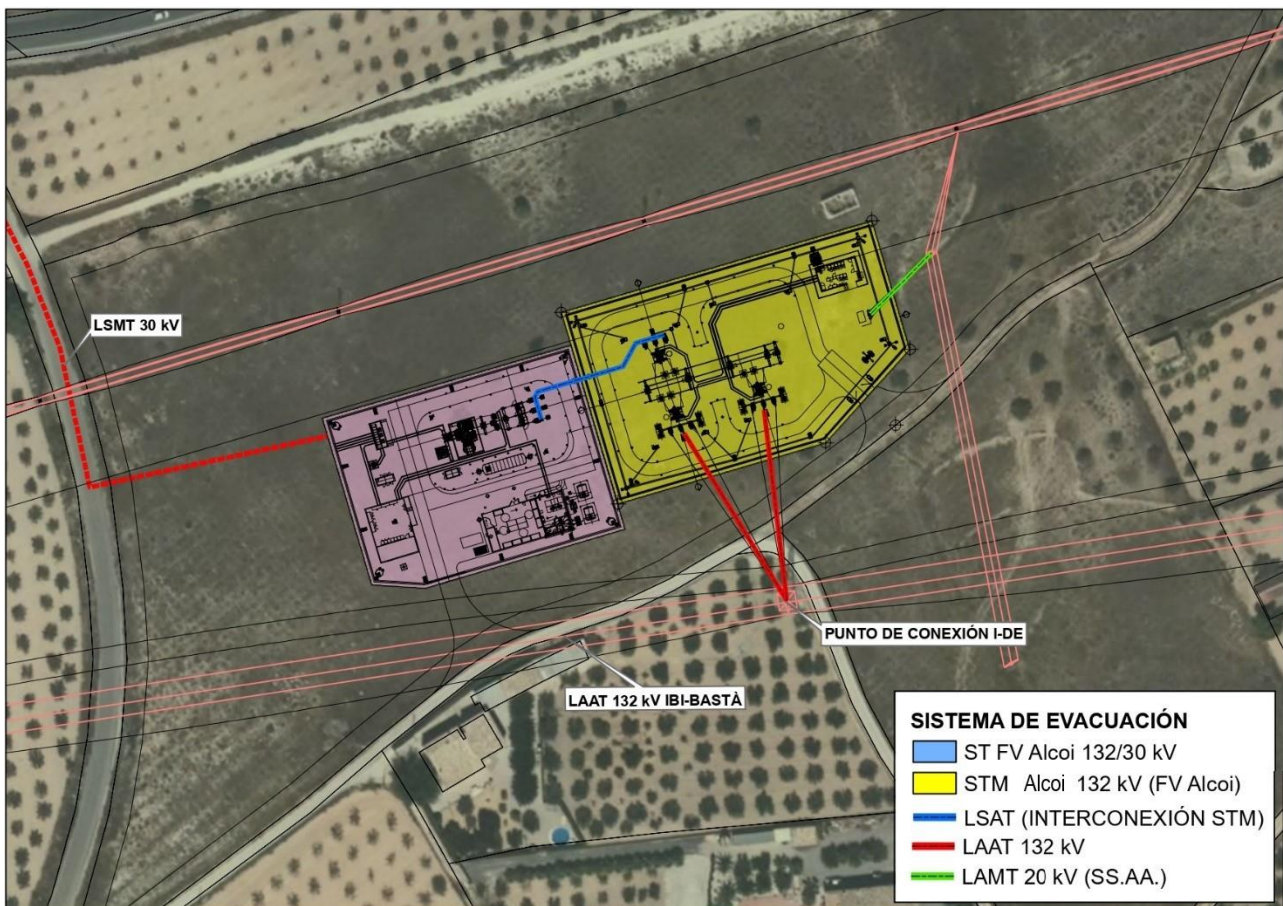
Implantación de las infraestructuras de evacuación, maniobras y conexión de la PSFV Alcoi
